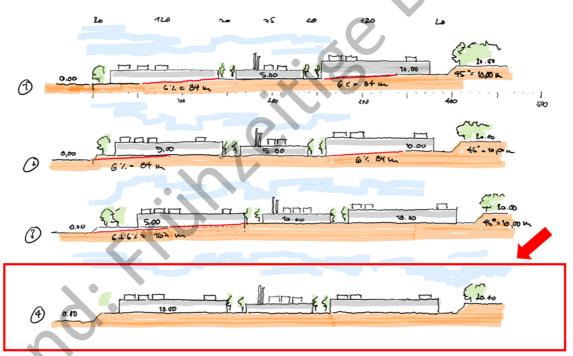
Angedachte Terrassierung gemäß Masterplan - Option 4
